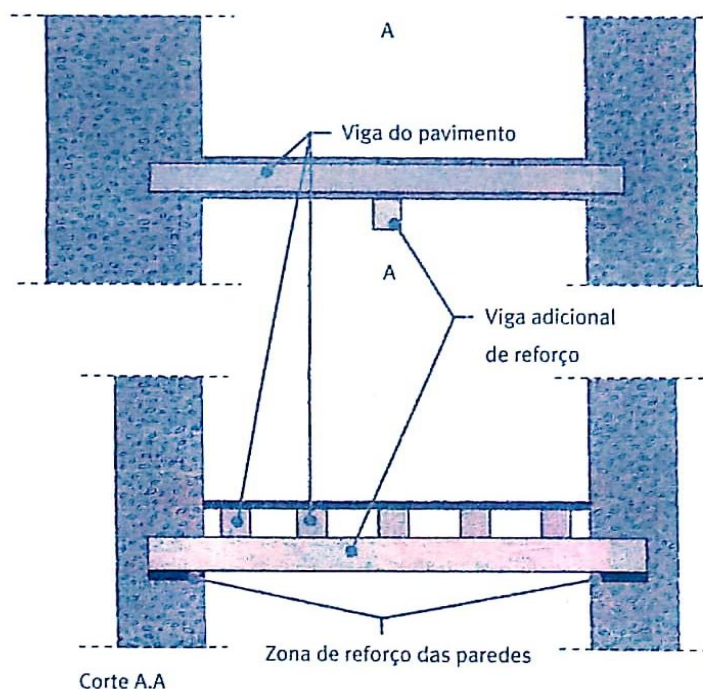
Viga transversal ao vigamento do pavimento [9]
